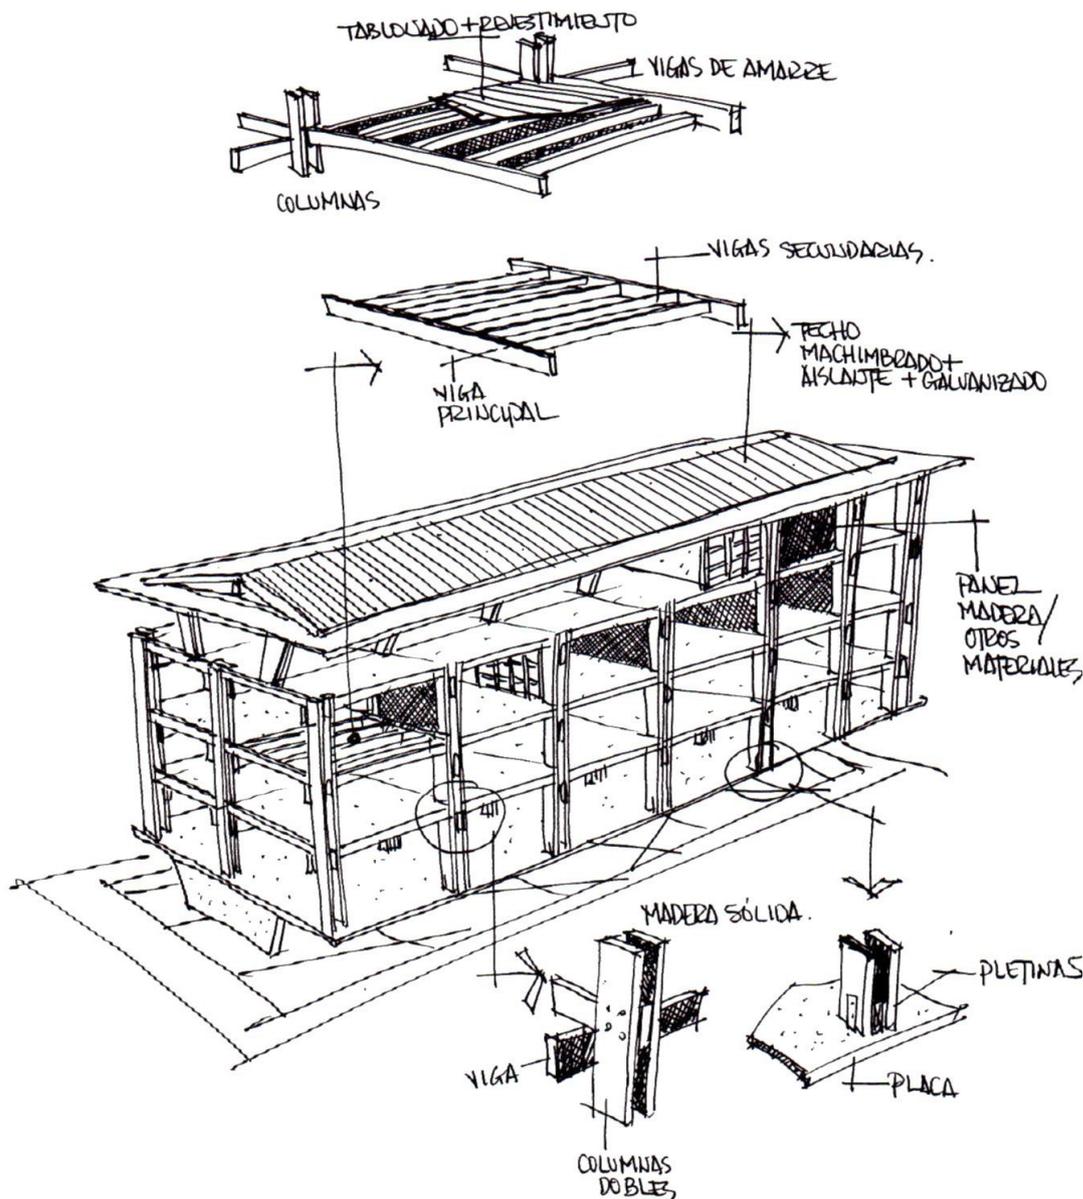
Alternativa A2, donde se muestra el sistema estructural del tipo vigas laminadas encoladas. Fuente: Arq. Dr. Wilver Contreras y Dr. Ing. Eric Barrios.
